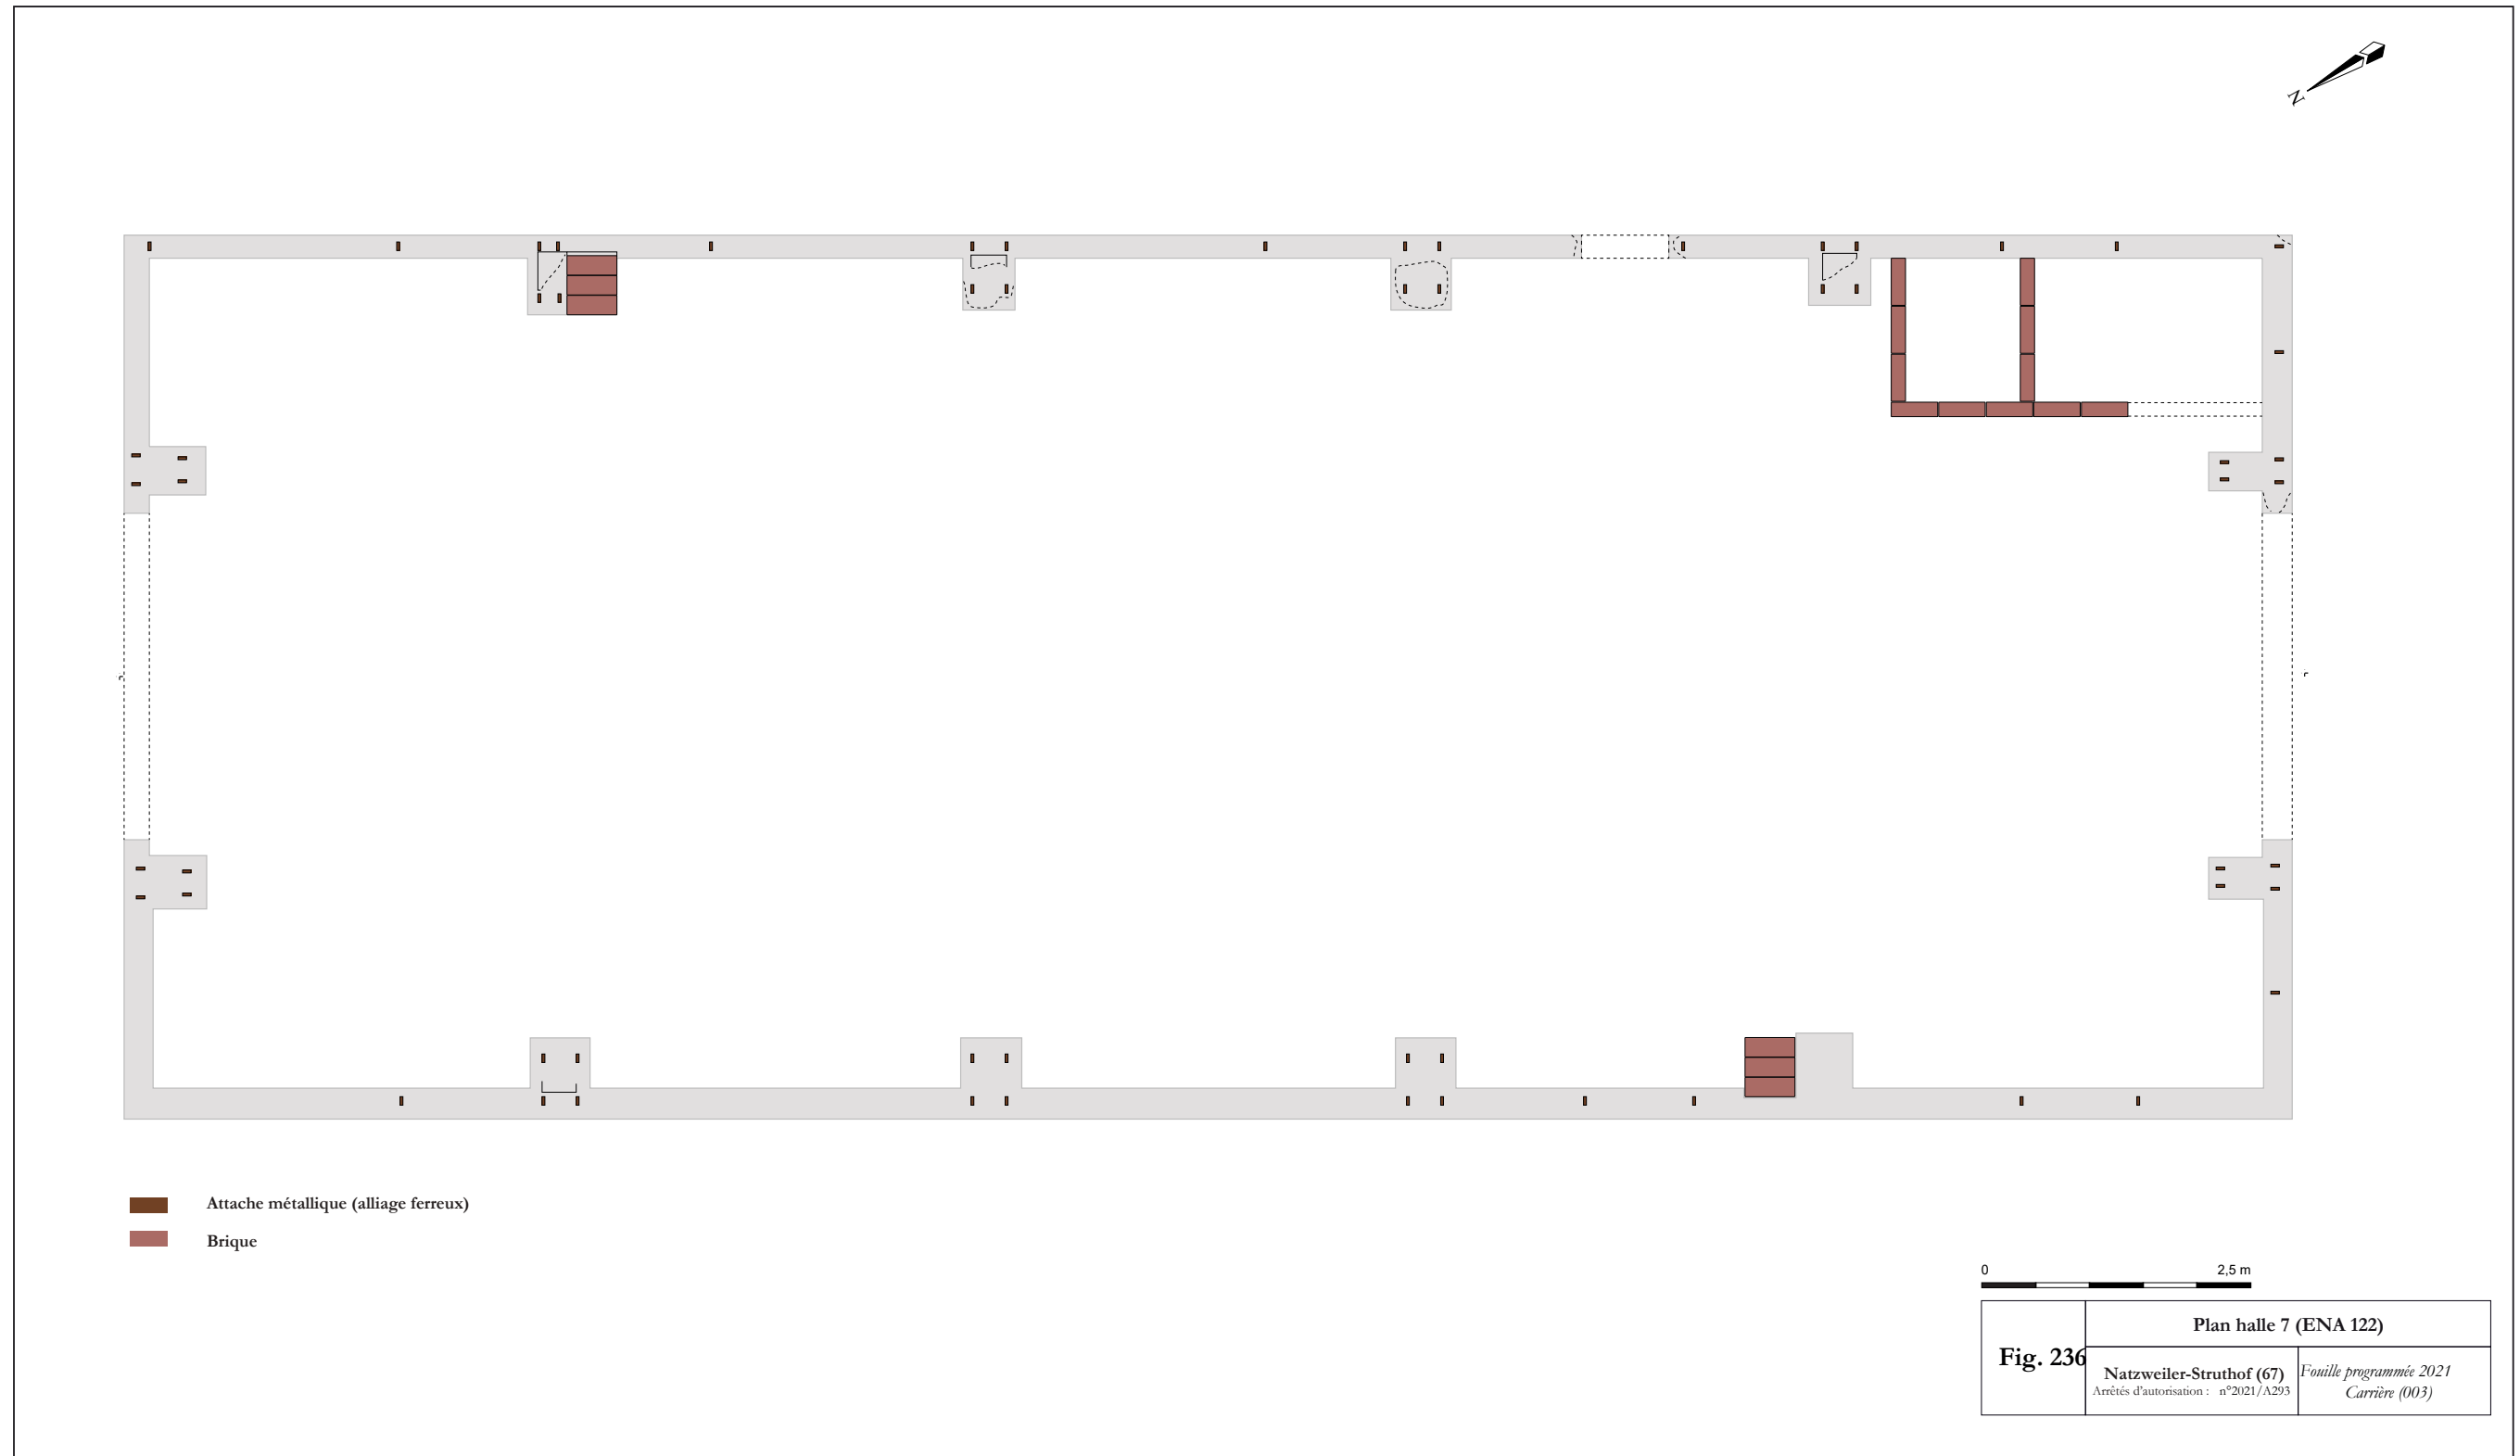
Plan de la halle 7, ENA 122 (DAO : T. Aubry et J. Brangé).
